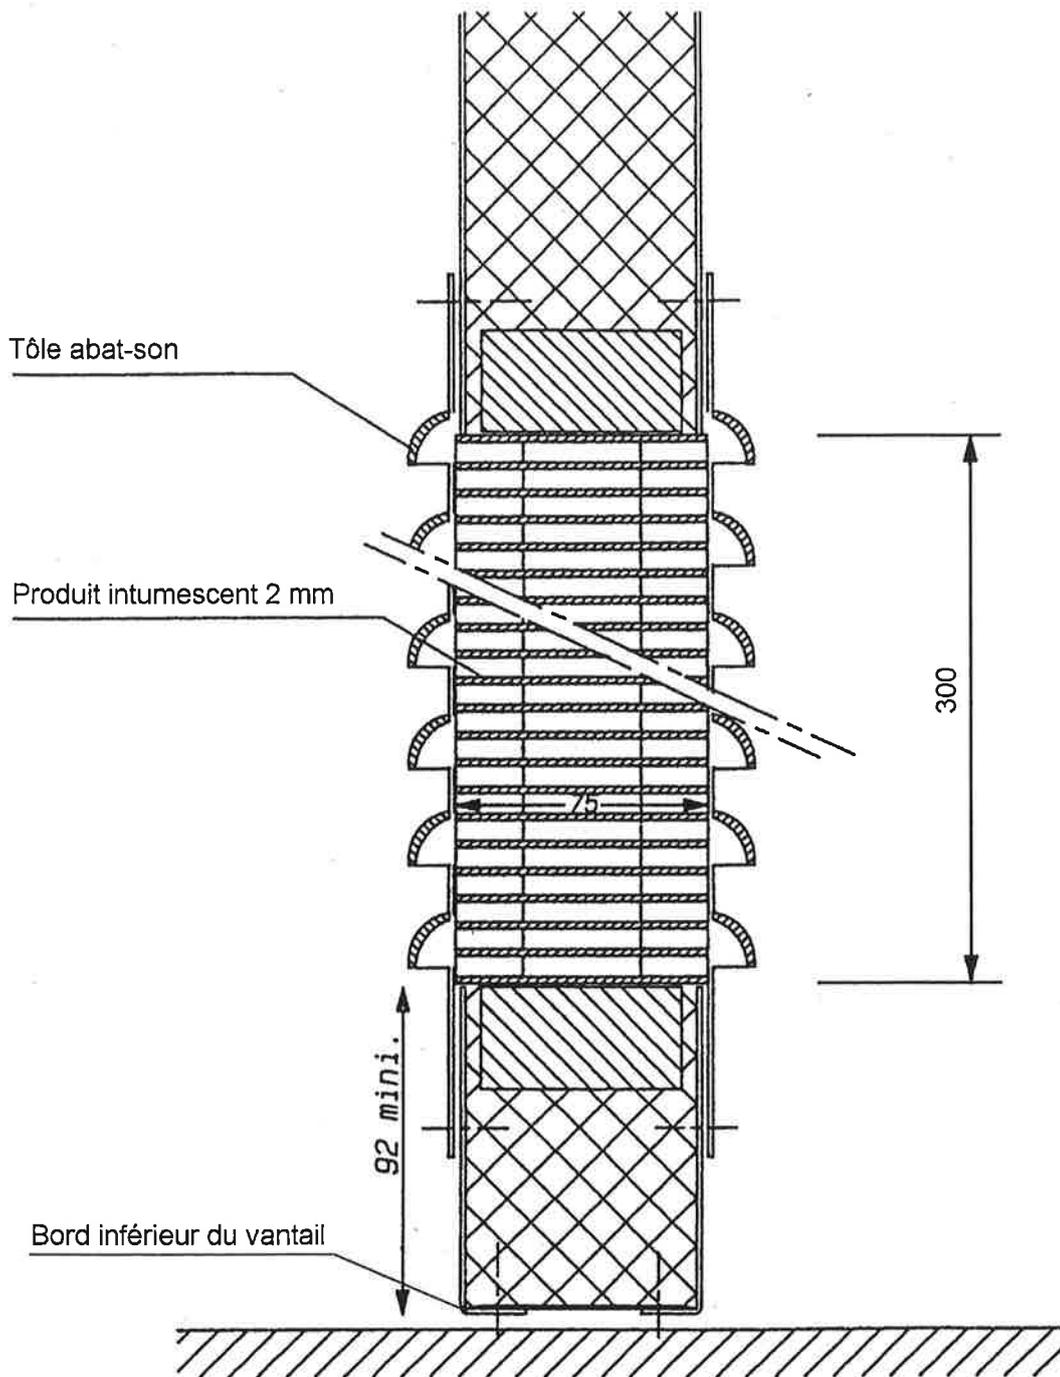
Coupe verticale de la grille de ventilation en bas du vantail
